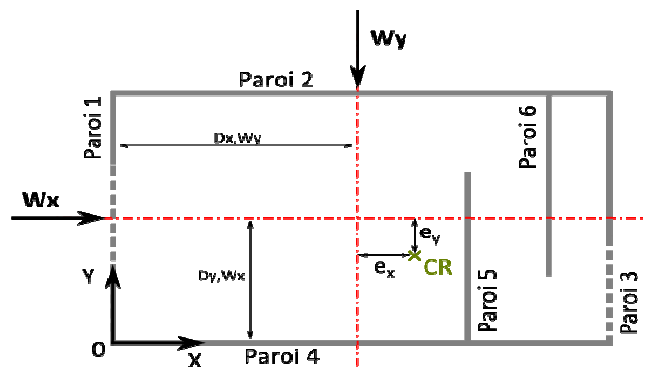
Vue en plan d'un bâtiment avec 6 parois utiles au contreventement (Source : CrittBois)
